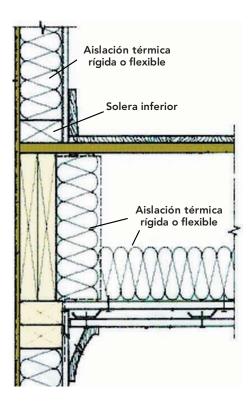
13: Aislación de viga perimetral, y entrepiso segundo nivel.
